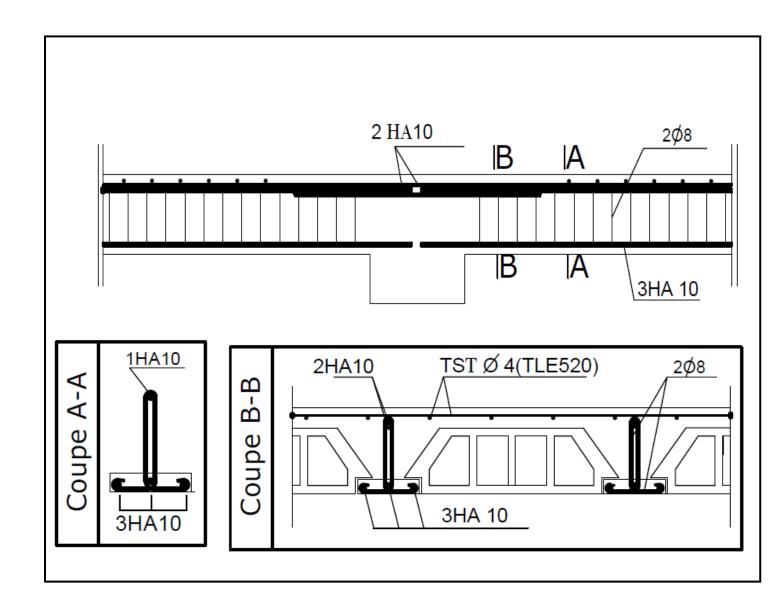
Plan de ferraillage du plancher en corps creux.
